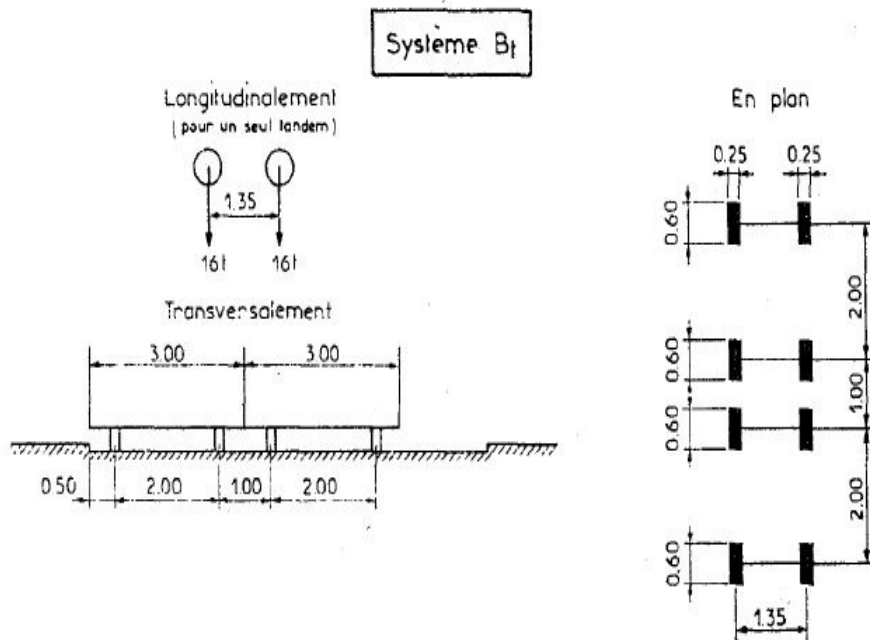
système Bt longitudinalement, transversalement et en plan
